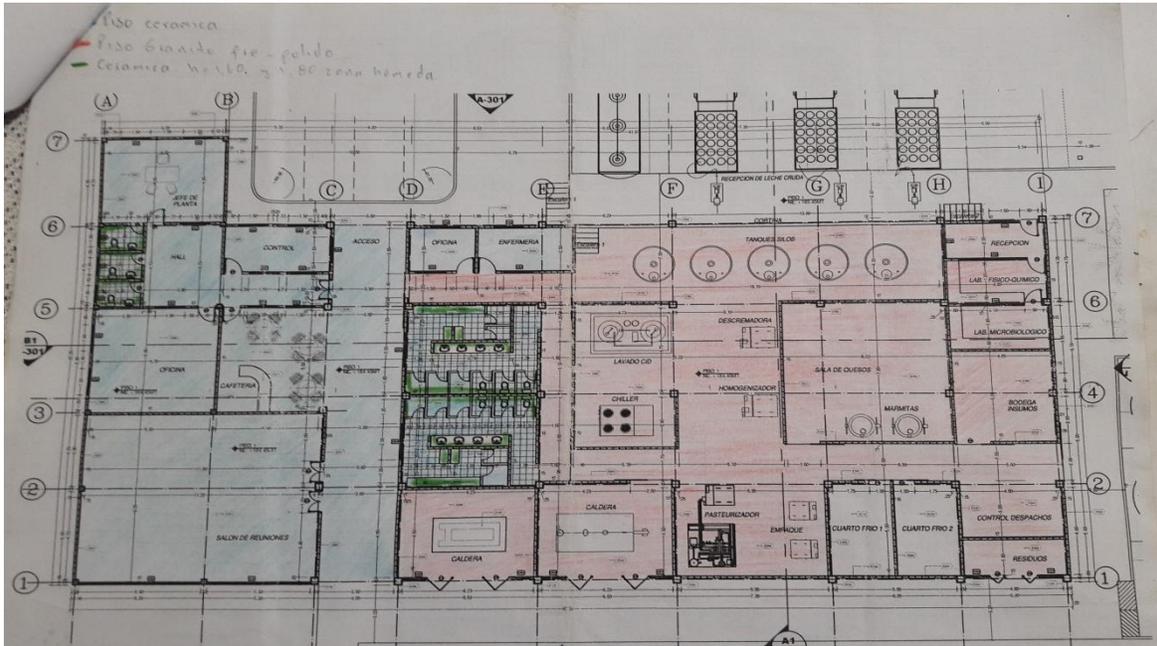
Plano record de planta del área administrativa e industrial (planta).
